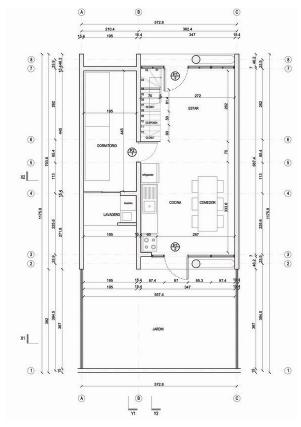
Planta Primer piso vivienda social mapuche. Fuente: Plataforma Arquitectura.
